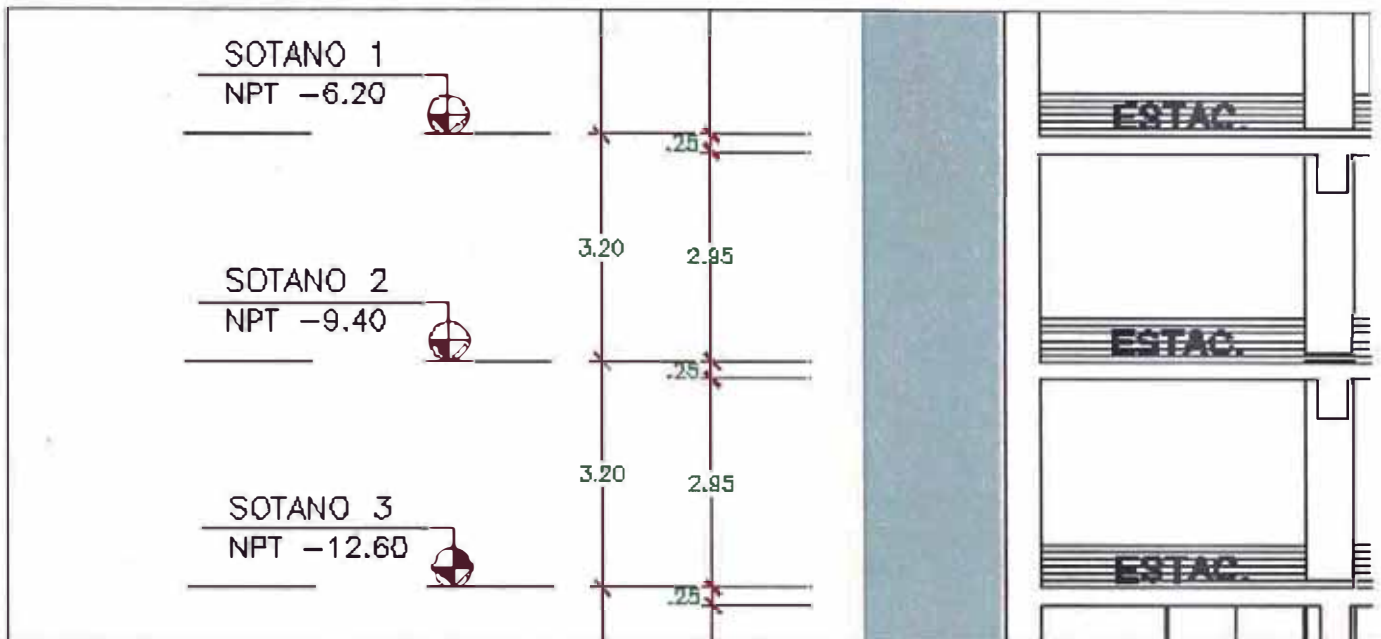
Elevación de estacionamientos Fuente: Planos de arquitectura del proyecto
